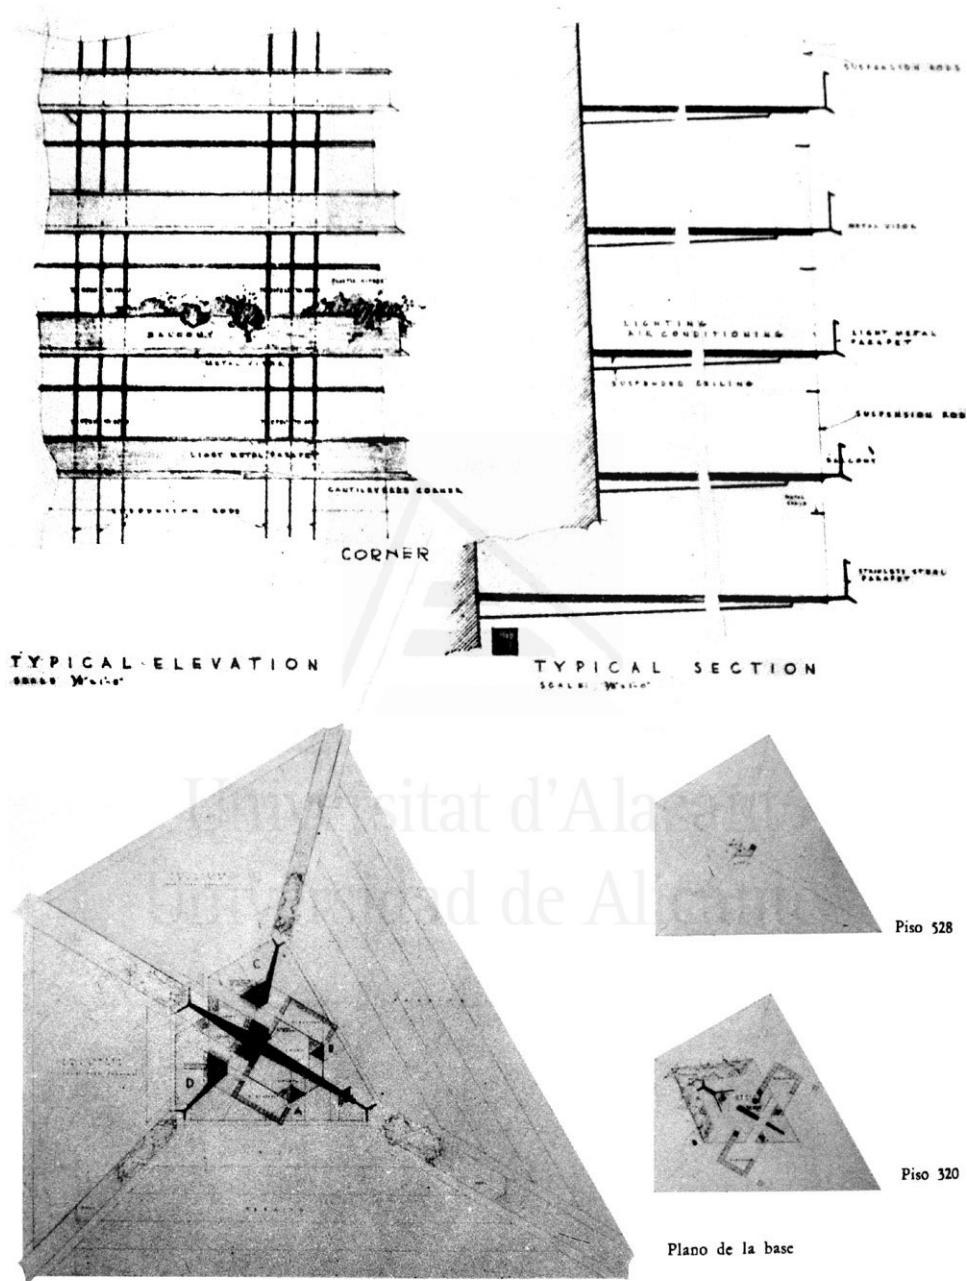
Torre Illinois de una milla de altura (1956), Frank Lloyd Wright. Detalles de la fachada y de la sección y plantas: planta baja y niveles 320 y 528. Ilustraciones extraídas de "Testamento" (Wright, 1961, pp.200-201).
